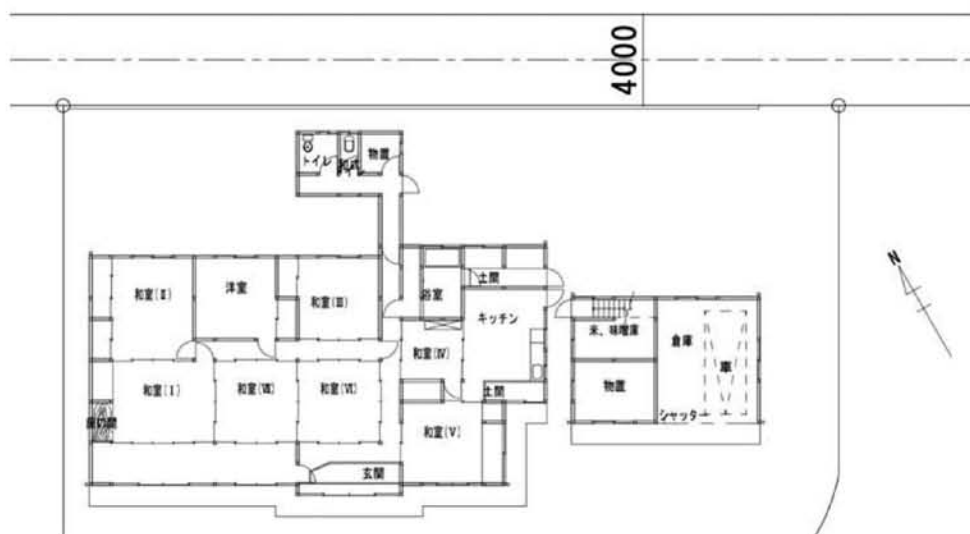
浪江町実測住宅配置図兼 1階平面図 S:1/200
